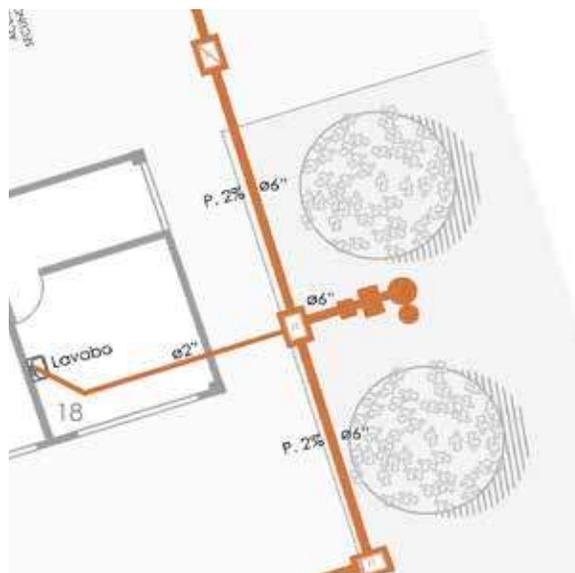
Vista en planta de Biodigestor/Elaborado por LAS
